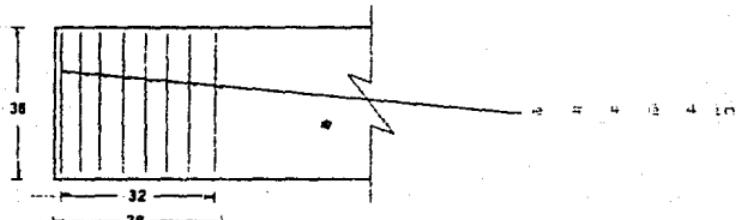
Croquis de armando para los extremos de la viga del procedimiento tratado
